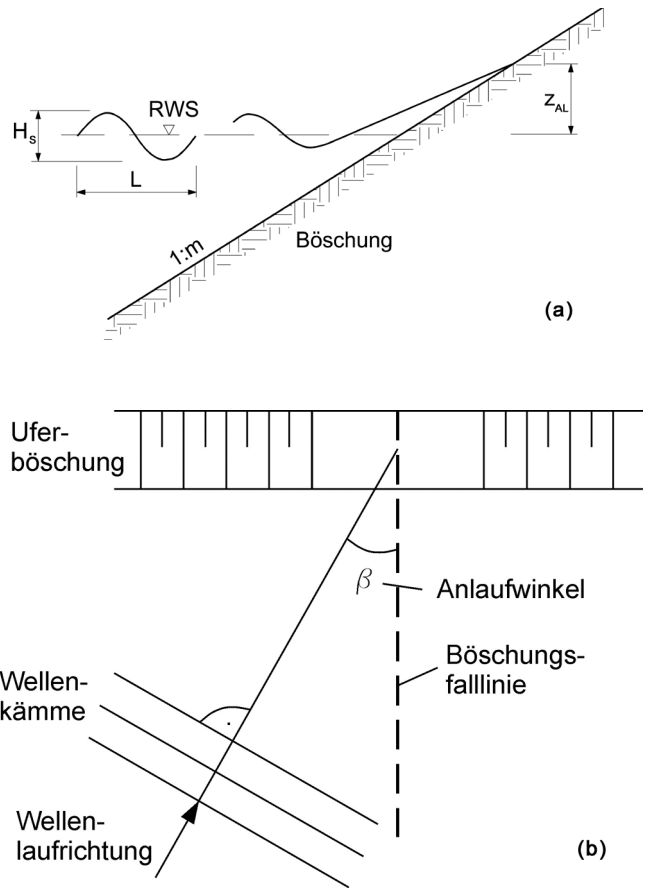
Definitionen zur Wellenauflaufhöhe z_{AL} : (a) Querschnitt, (b) Draufsicht
